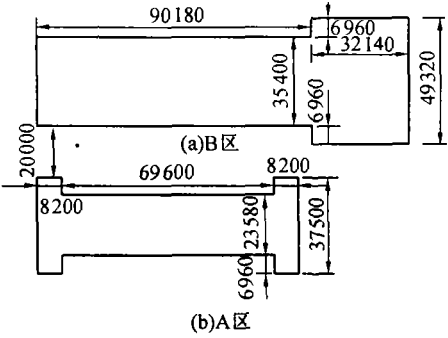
卢扬涵闸软基加固区平面示意图(单位:mm)
